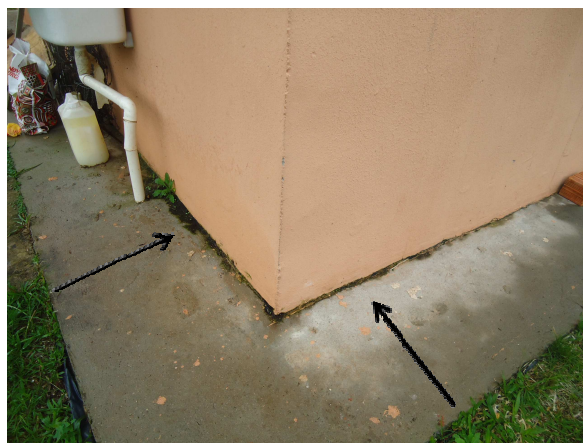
Ligação parede/radier, onde ocorre infiltração a partir do banheiro.
